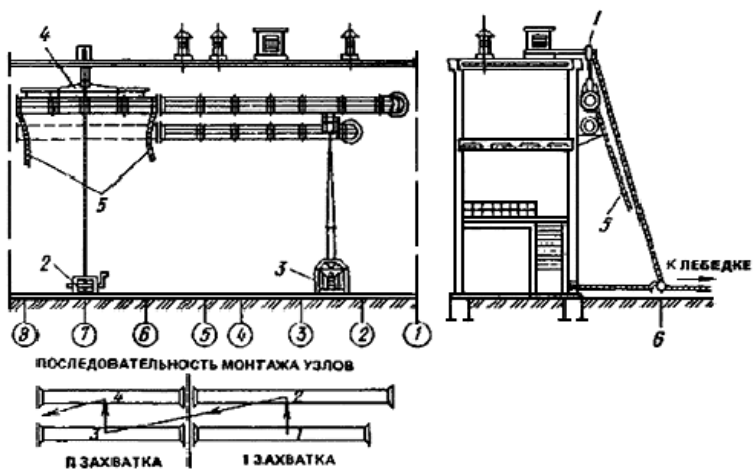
Схема организации рабочей зоны при монтаже воздуховодов по наружной стене здания:
